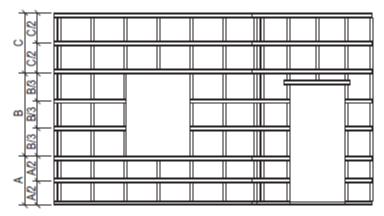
Монтажная схема горизонтальной обрешетки для стен типа 1
